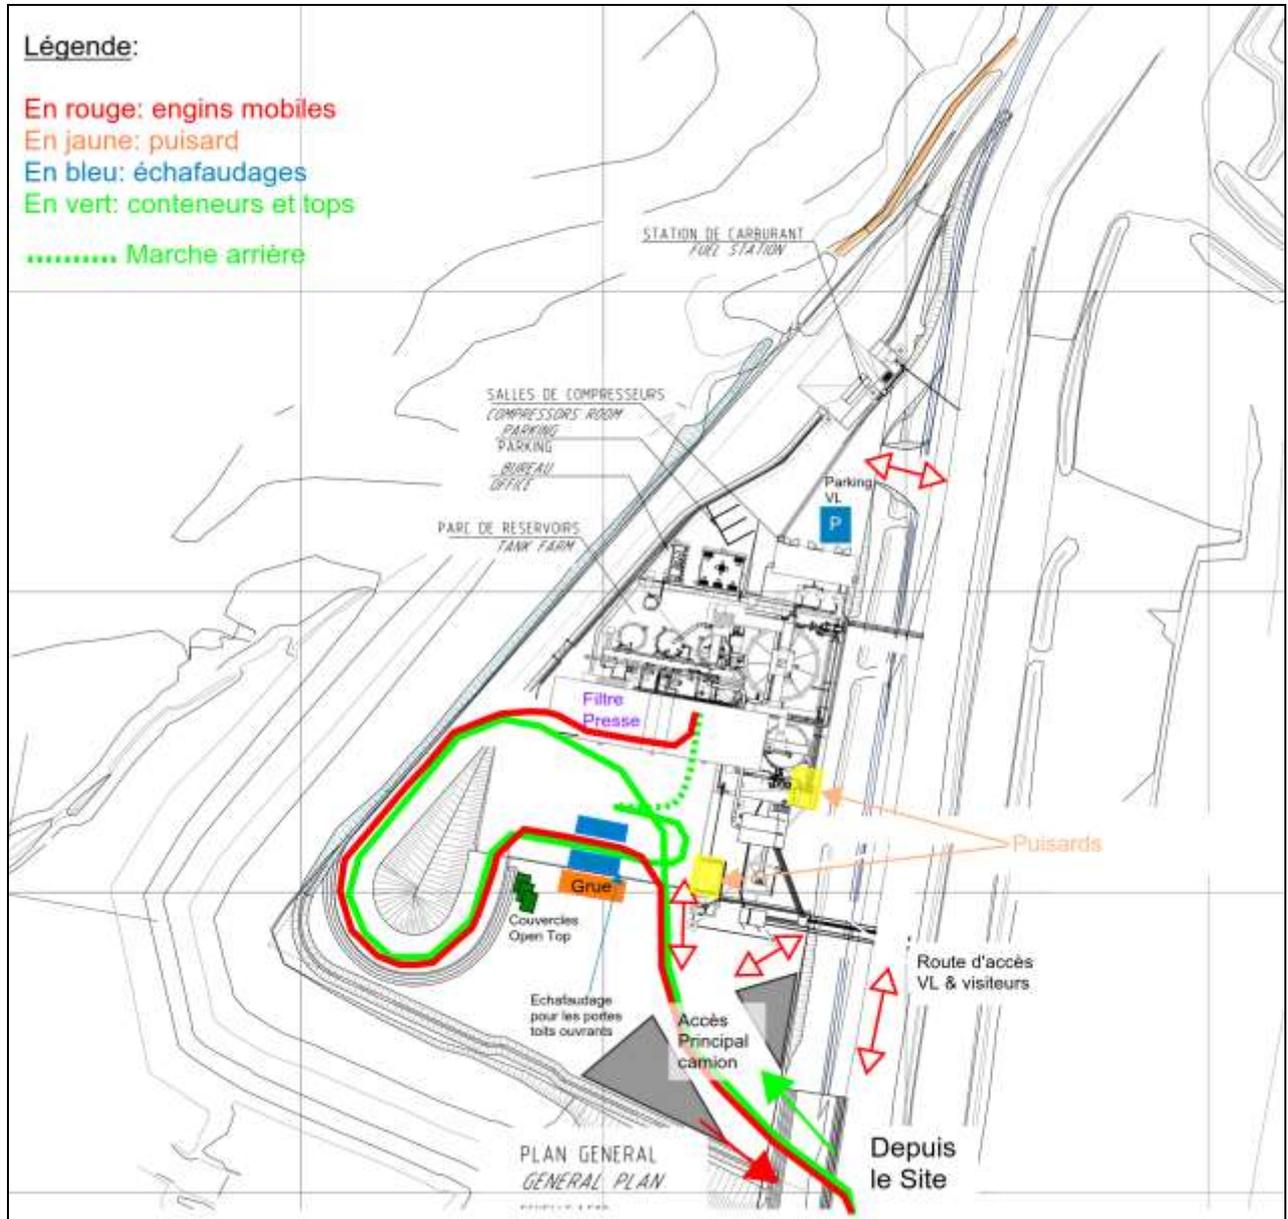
Plan de circulation sur la zone de l'usine DWP1
